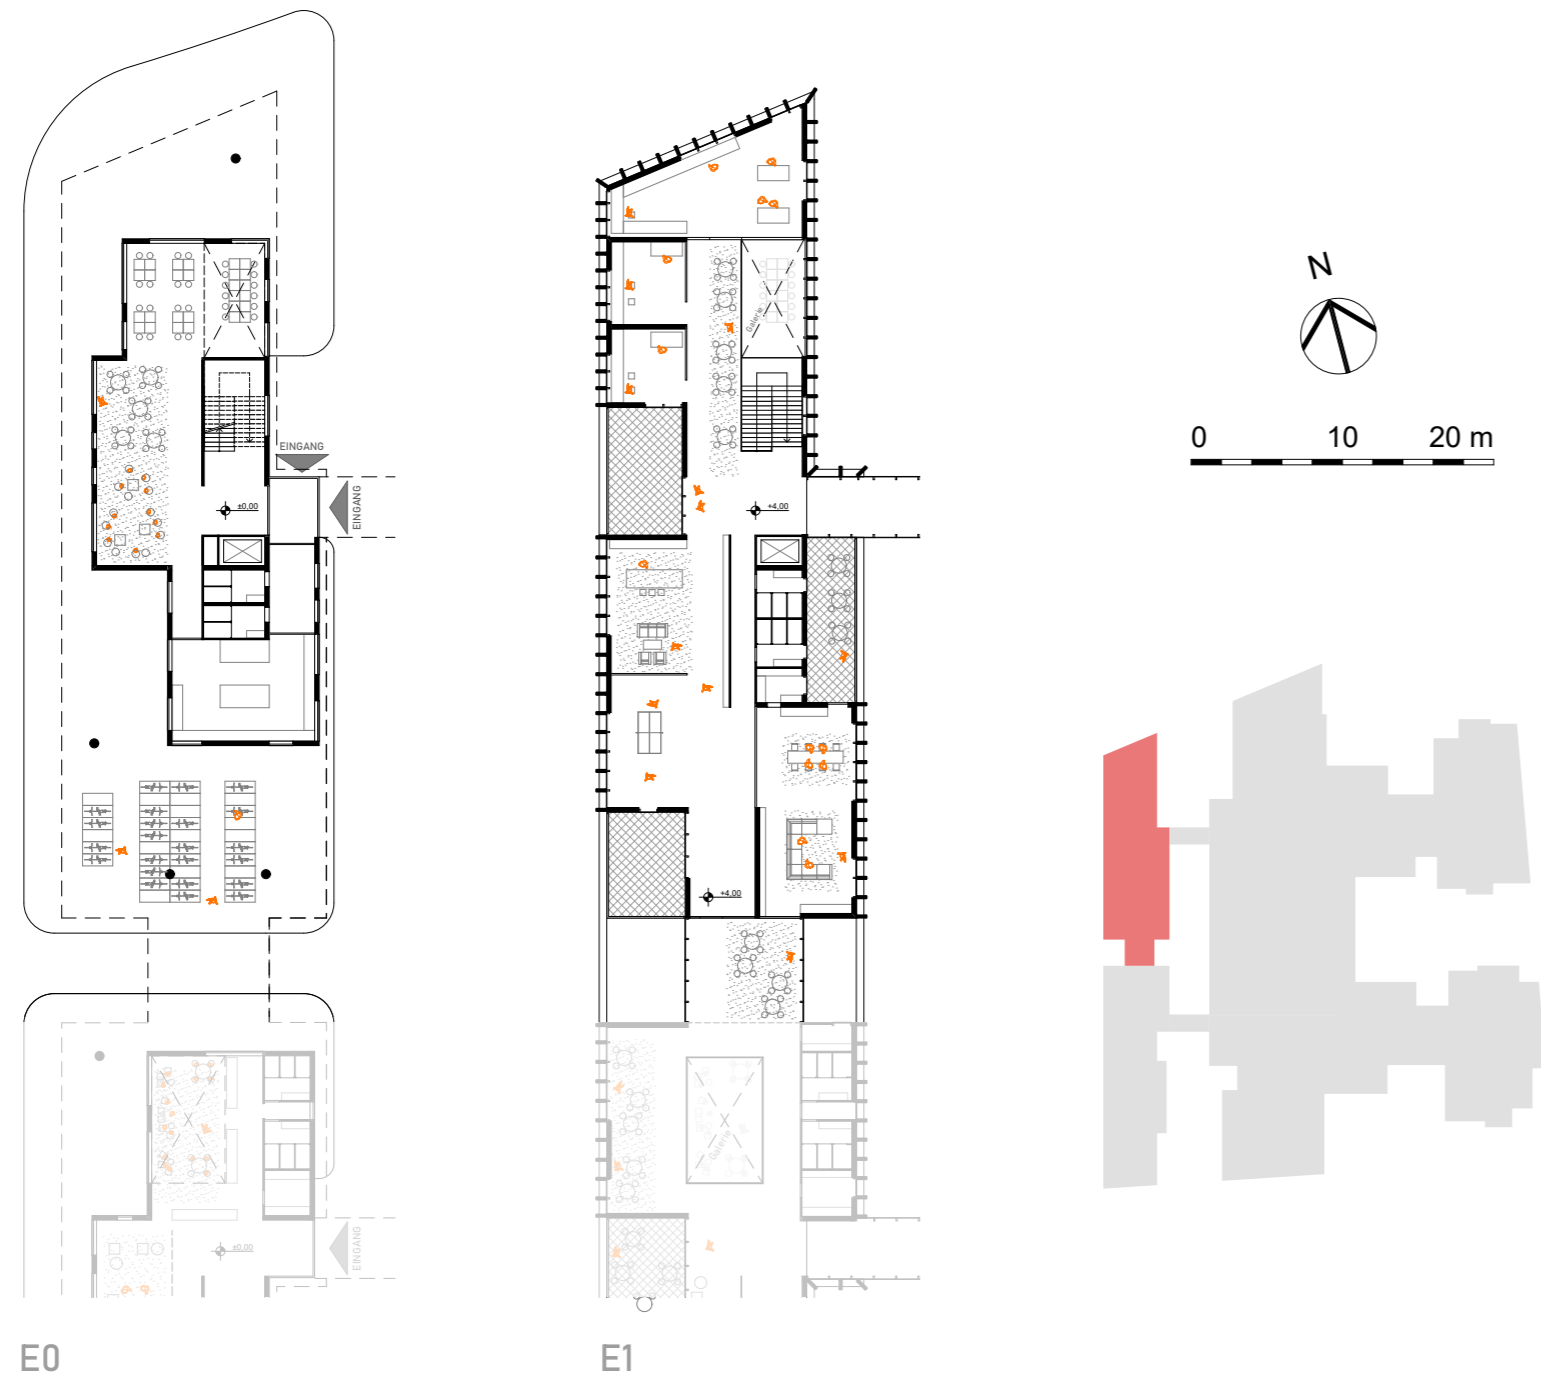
Grundriss Abschnitt-Fablab/Jugendzentrum
